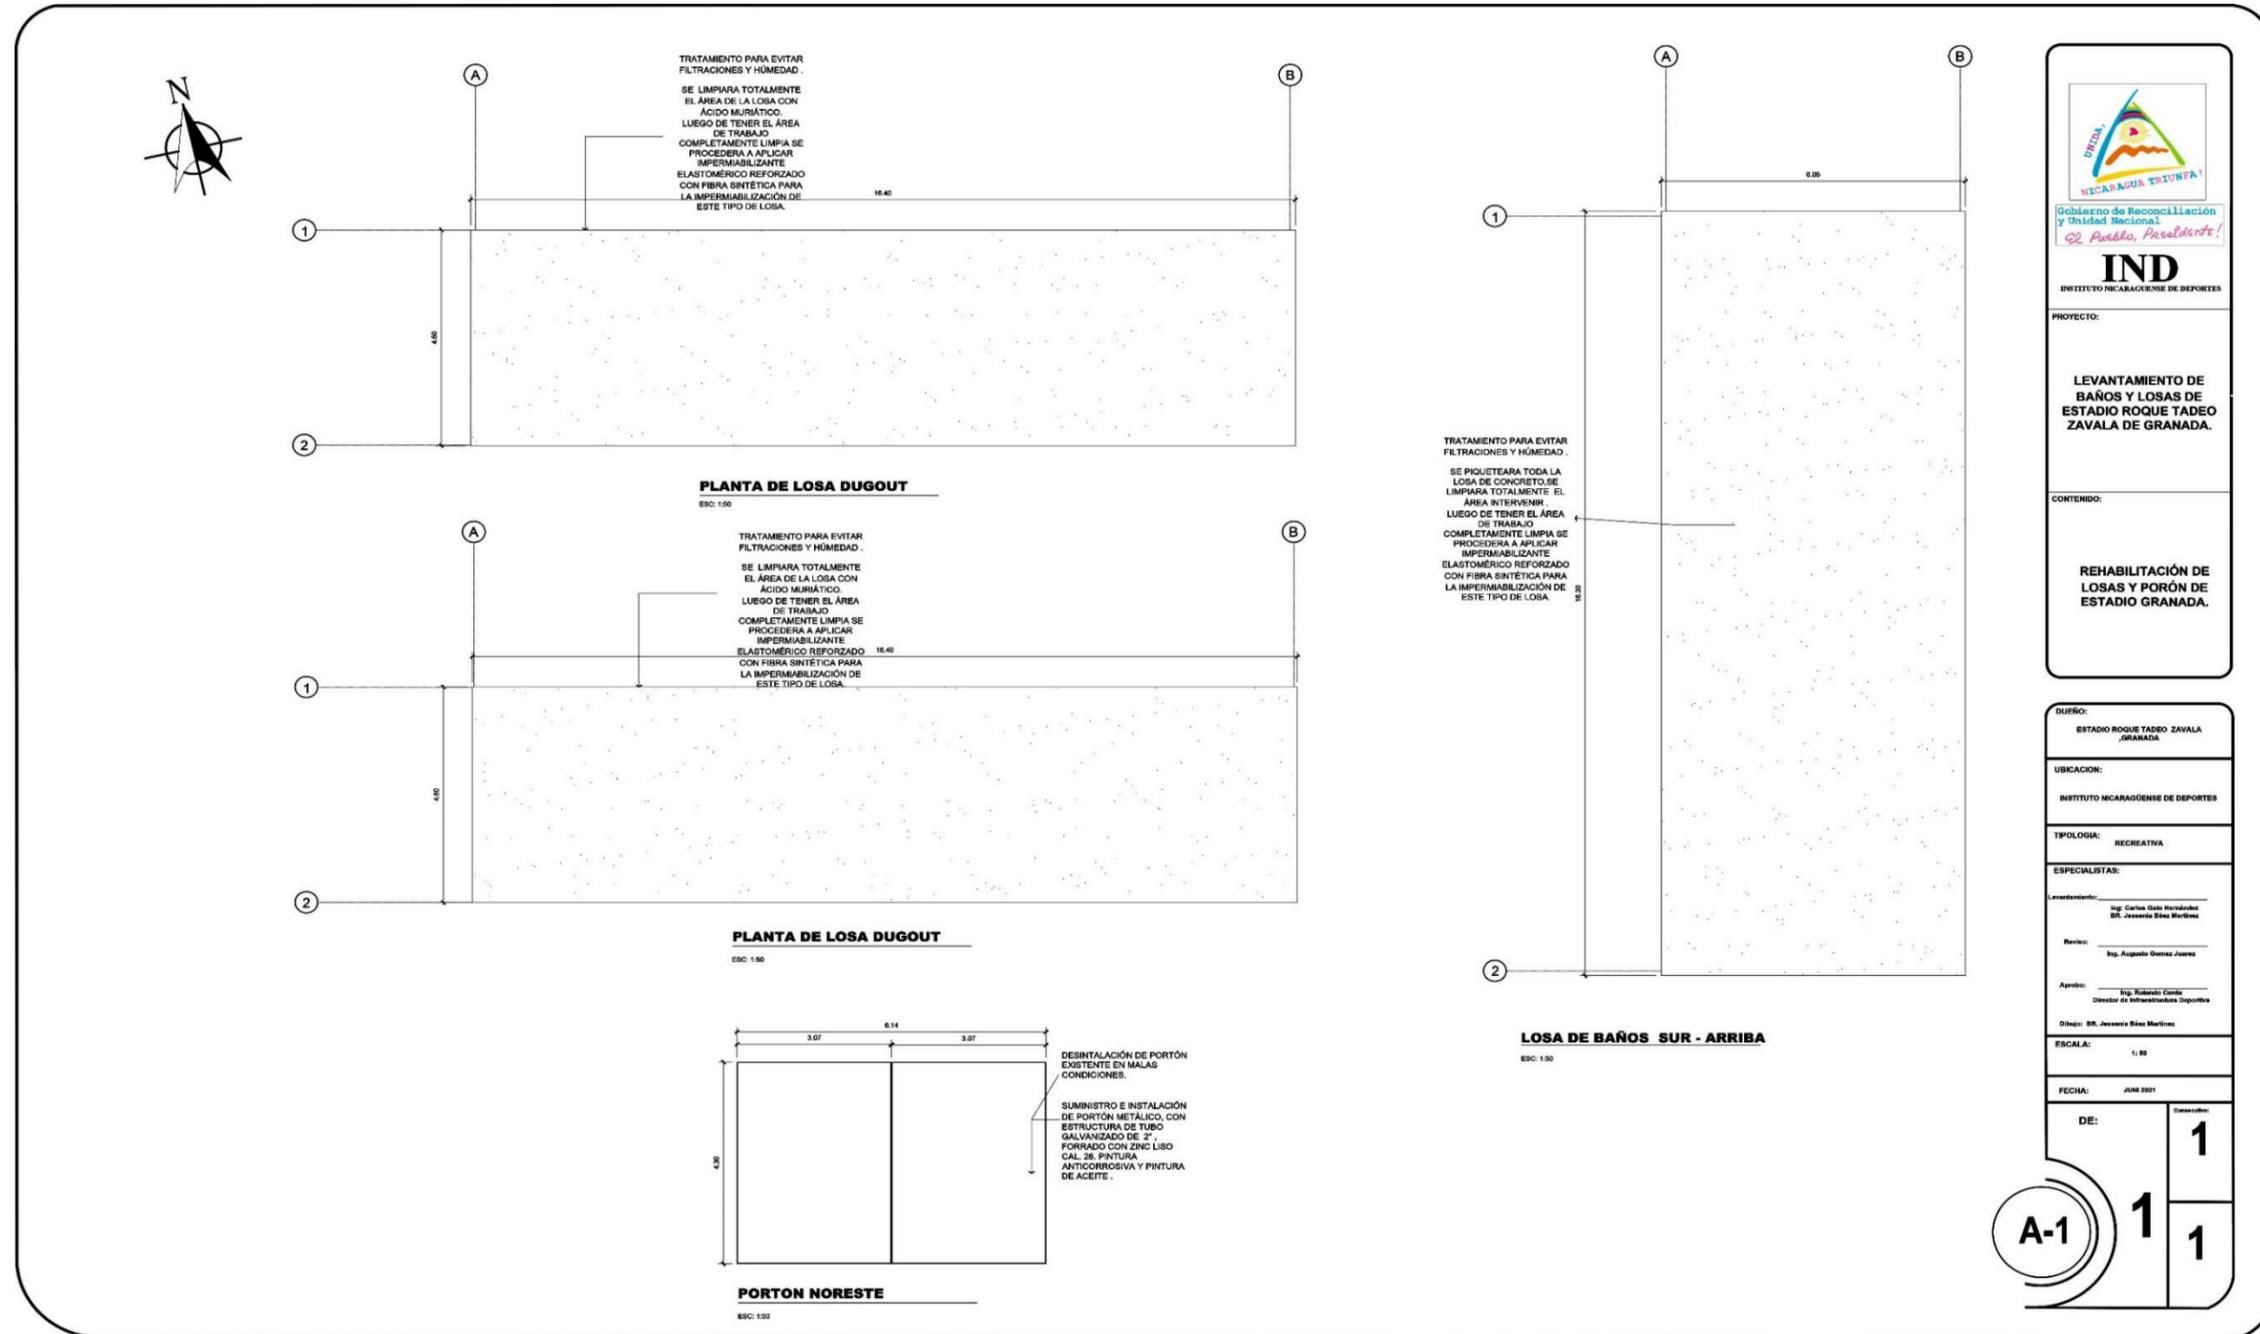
Planos arquitectónicos de losas y portón Noreste del Estadio Roque Tadeo Zavala
